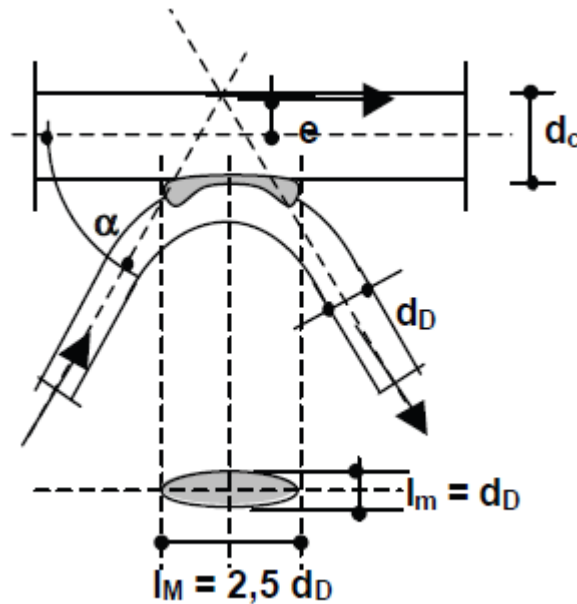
Esquema de soldadura celosía-cordones (Viga de filigrana)
